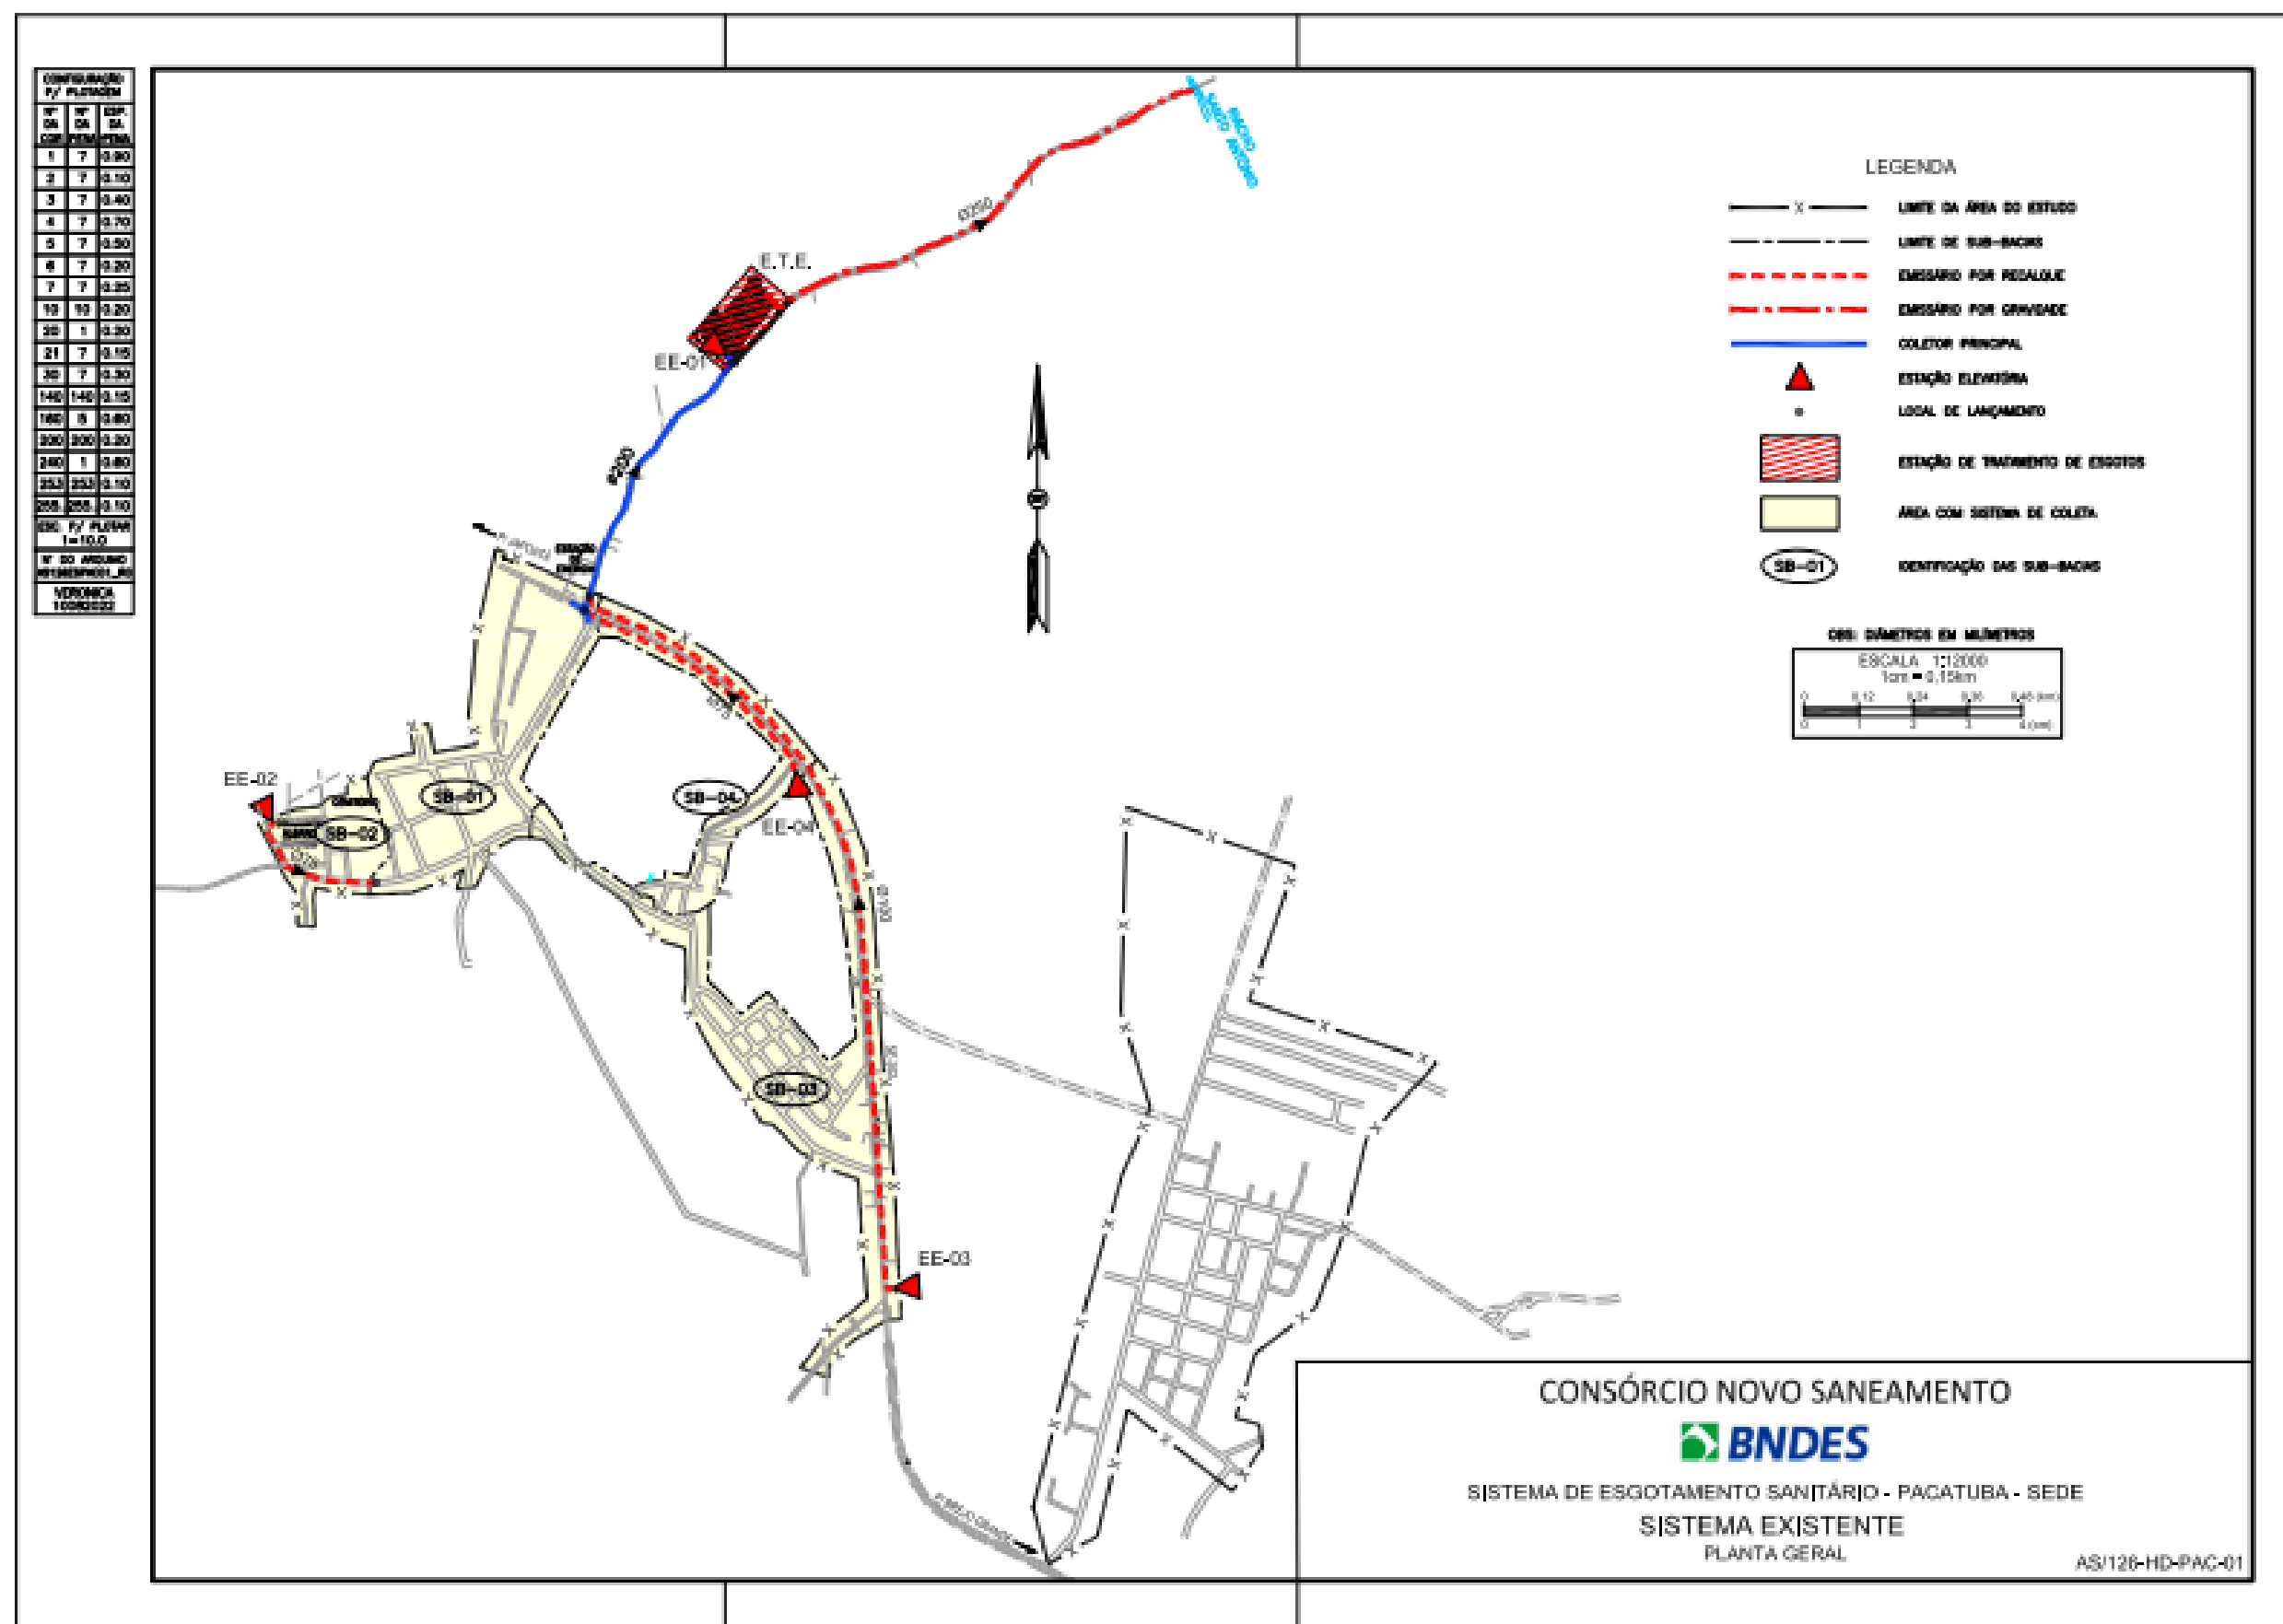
Planta do Sistema de Esgotamento Sanitário – PACATUBA
